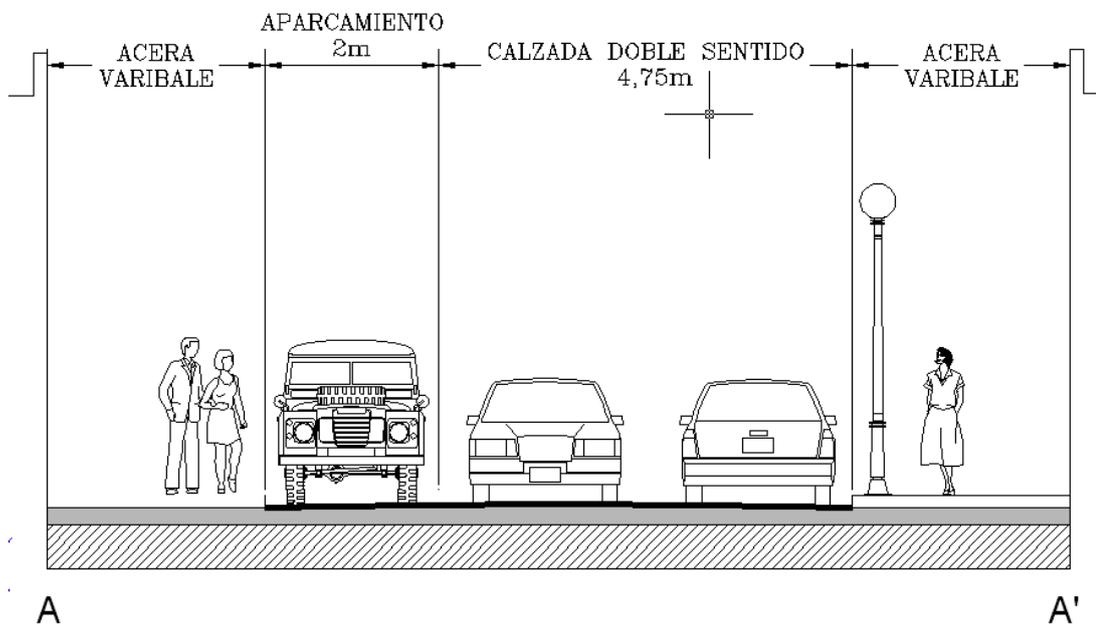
Sección tipo propuesta para vía bidireccional con banda de aparcamiento.
